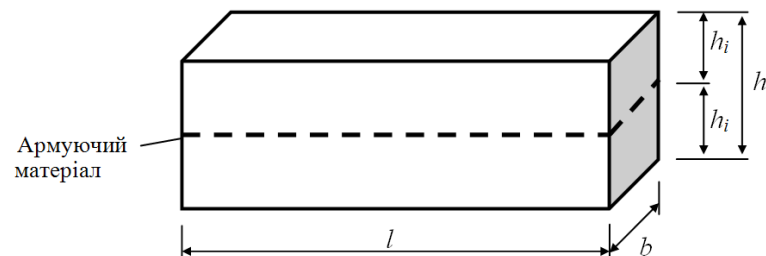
Схема розпилювання плит армованого асфальтобетону
